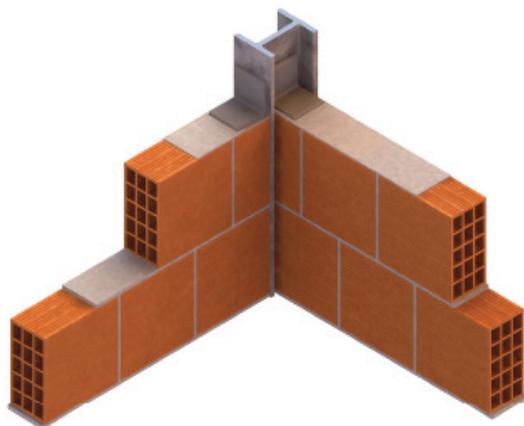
Collegamento alla struttura metallica tramite staffe di acciaio disposte nei giunti orizzontali.
